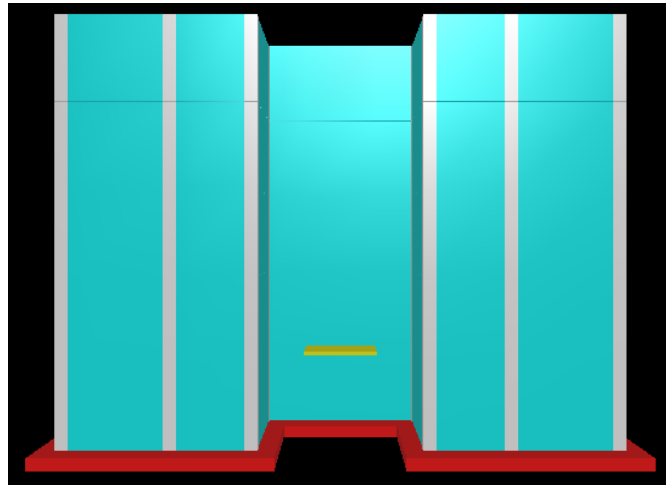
Pórtico 3D da estrutura em concreto armado com *radier*.
